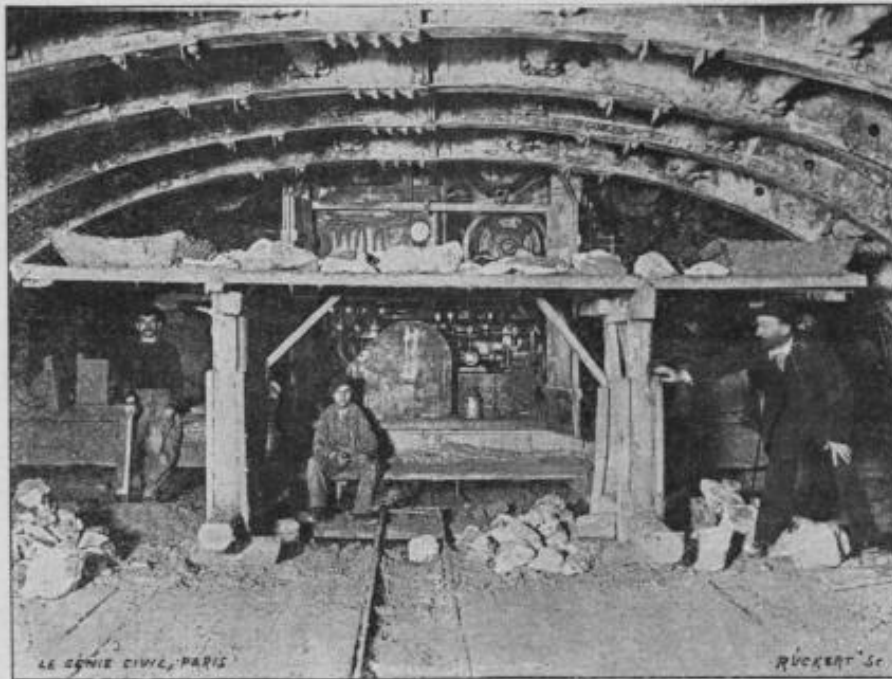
Arrière du bouclier se dirigeant sur la porte Maillot ;
